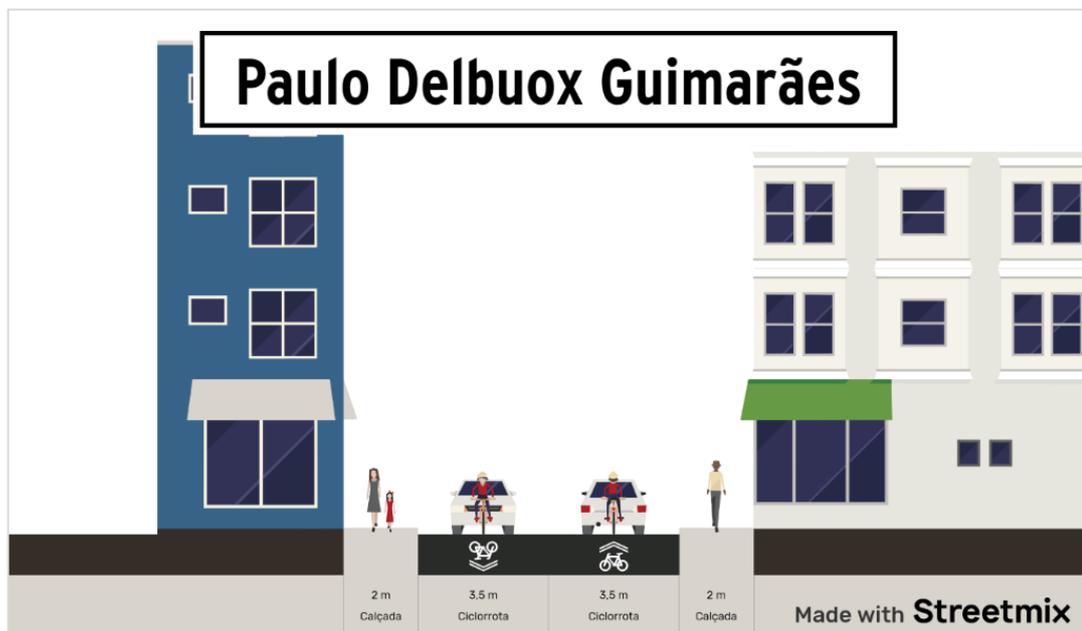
Proposta para Av. Paulo Delboux Guimarães. Fonte: Streetmix. Elaboração: Polo Planejamento (via Streetmix)
